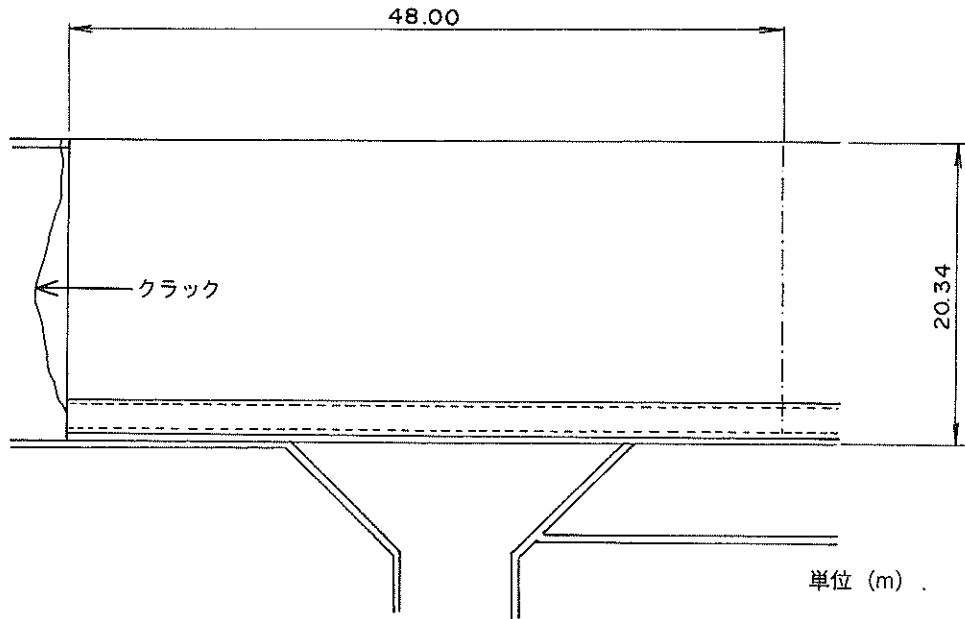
岸壁(-6.0m) (施設番号②)の平面図
